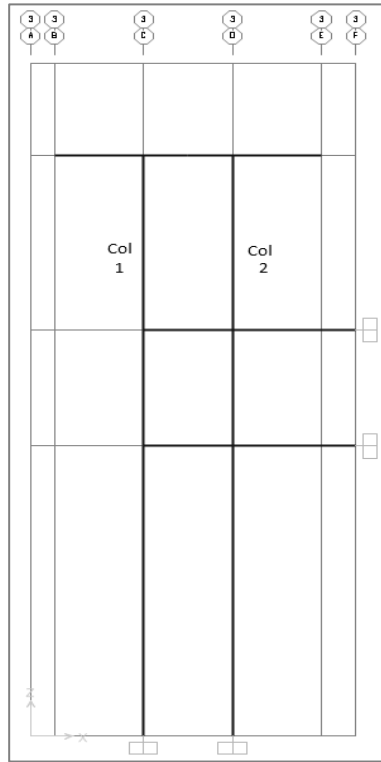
Columnas 1 y 2 en las que se apoya el módulo de la estructura
